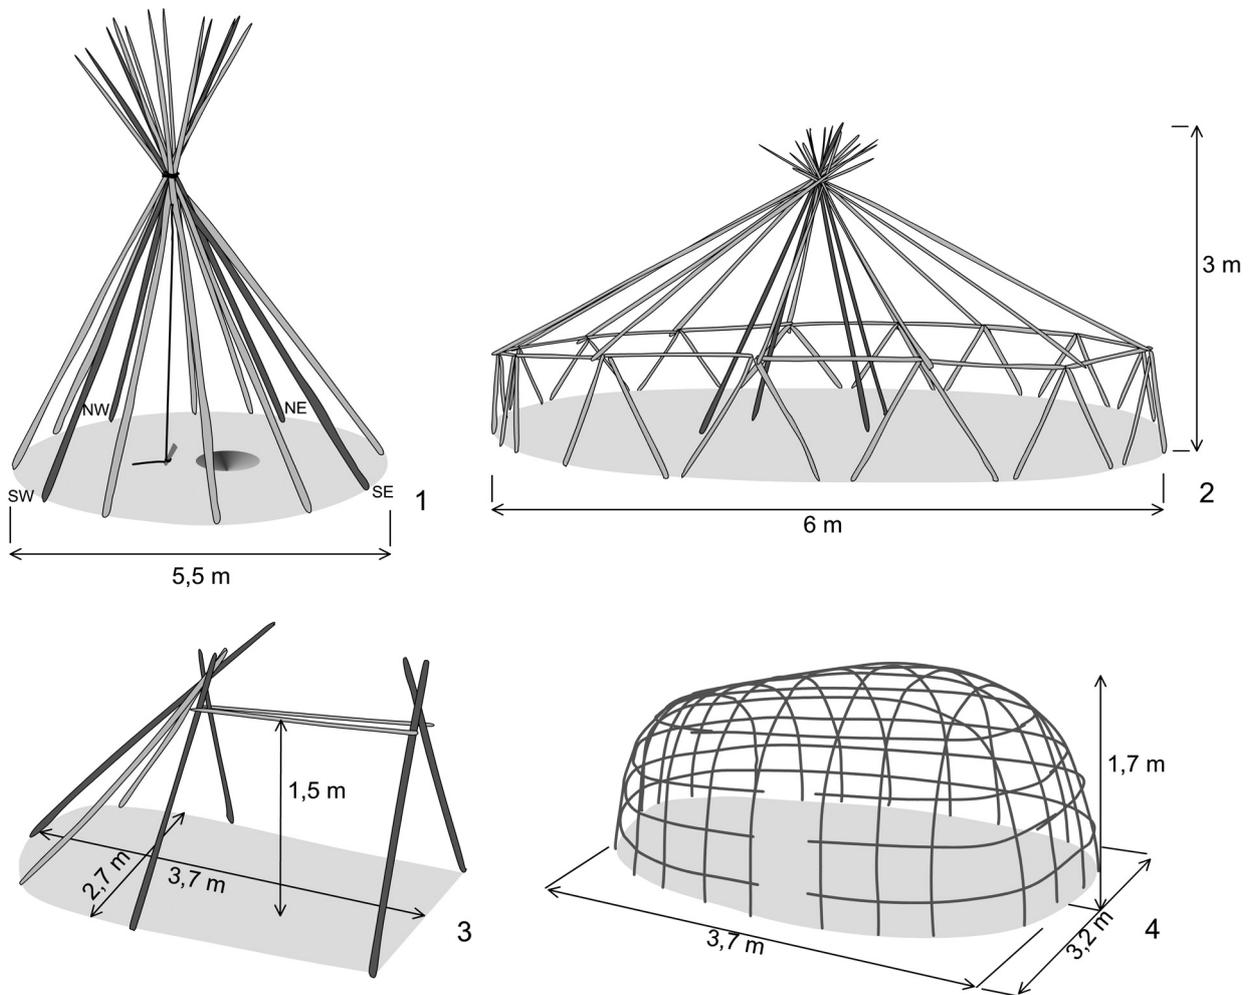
Gerüste von Zelten aus jüngster Zeit. – 1 Zeltgerüst der Blackfeet mit vier tragenden Stangen, die dunkelgrau markiert sind. – 2 Gerüst einer »Chorama-dyu« der Evenken, welches gleichfalls auf vier tragenden Stangen ruht. – 3 Gerüst für ein »tupik« der Central Eskimo. – 4 Rahmen eines Zeltes der Ojibway aus zusammengebundenen, biegsamen Baumstämmchen. Ergänzt nach Zeichnungen in Faegre 1979, 103. 129. 140. 155.
